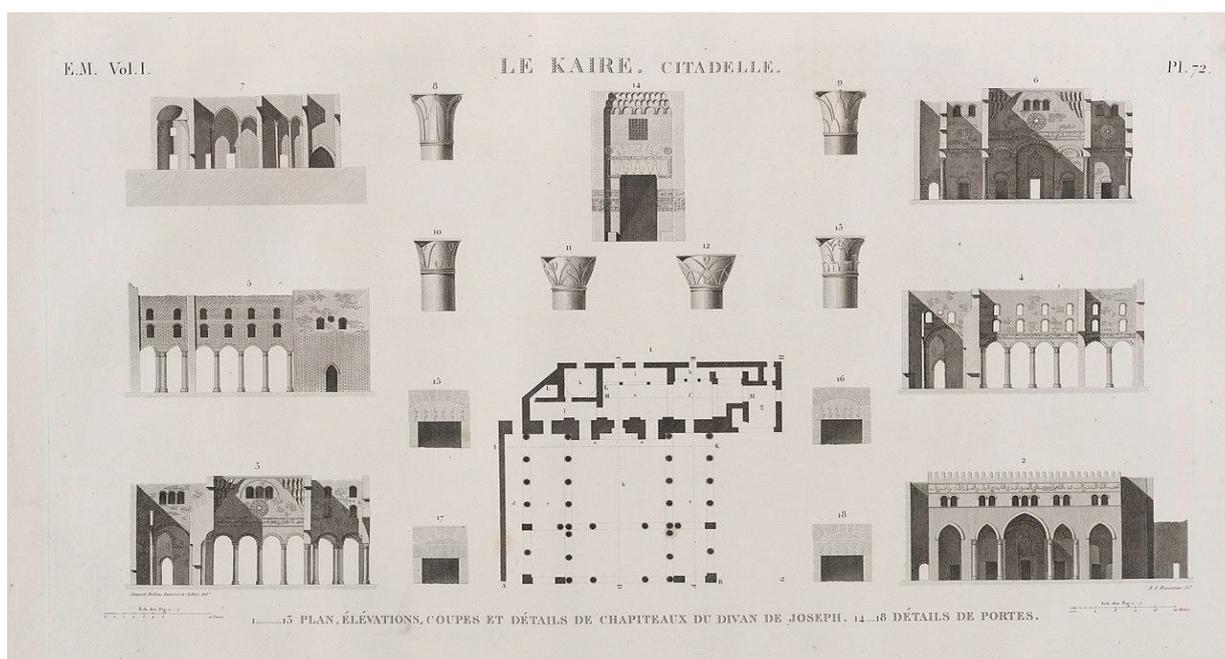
Planta baixa e vistas transversais do Grande Ivã do Cairo
